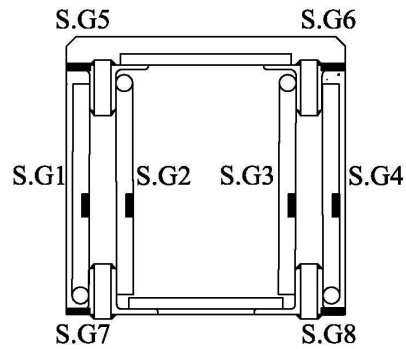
Posizionamento strain gauges trave in seconda fase: sezione tipo.
